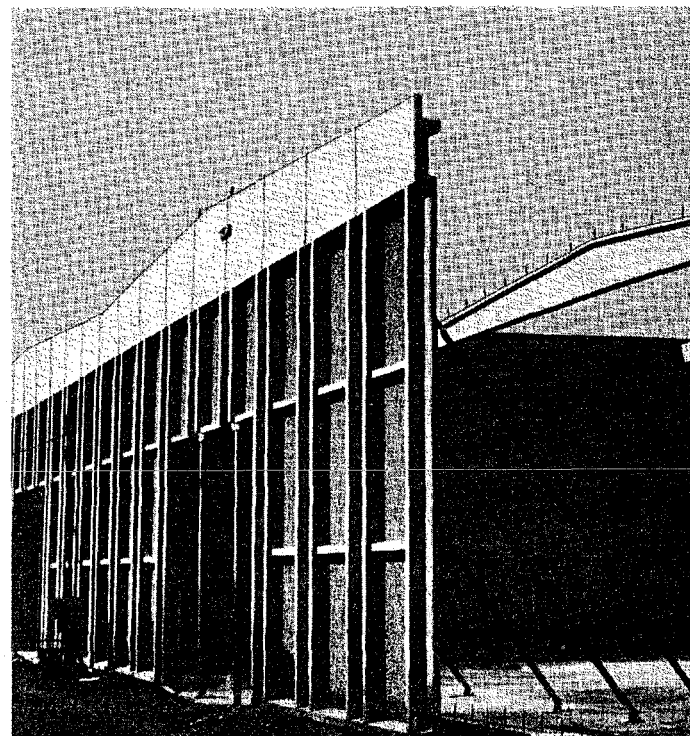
Lagerbygning for Pressens Fællesindkøb. Isolerede facadeelementer, hvor facade- og søjlefunktion er kombinerede.
